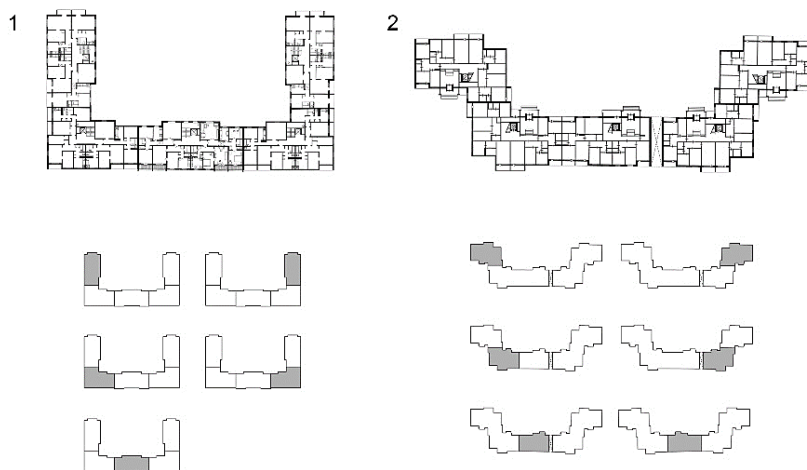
Поверхові плани житлового будинку 84-ої серії та типи блок-секцій (торцеві, кутові, рядові – з проходом на рівні першого поверху та без нього): (1) типовий проект ЦНИИЭП Жилища; (2) львівський варіант.
